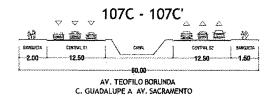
Sección vial Av. Teófilo Borunda. 50
